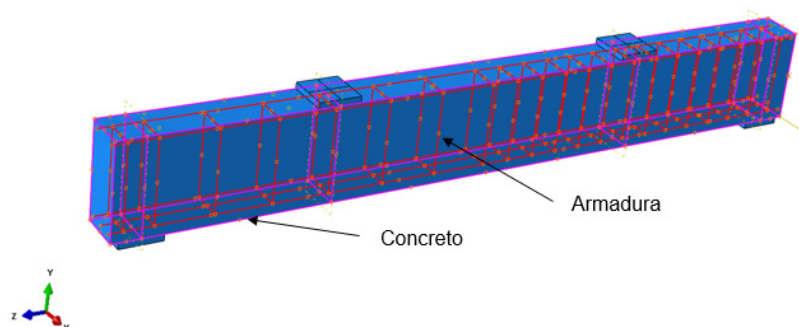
Armaduras embebidas no concreto (Autores, 2019).
